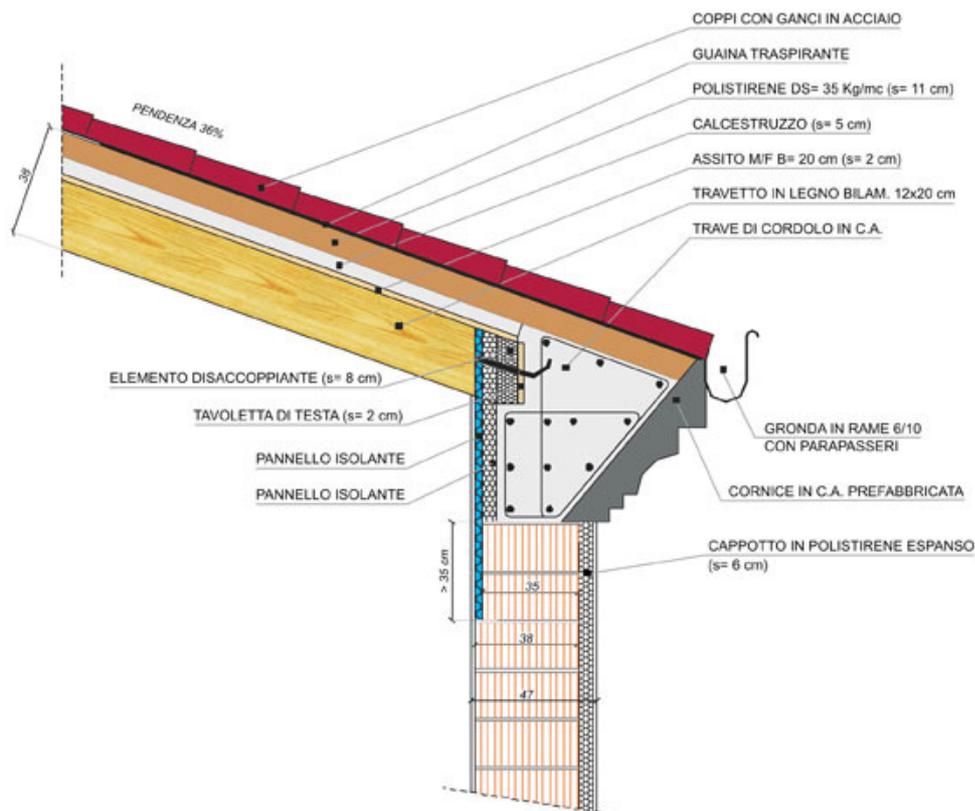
Cornicione di gronda in calcestruzzo prefabbricato faccia-vista.
